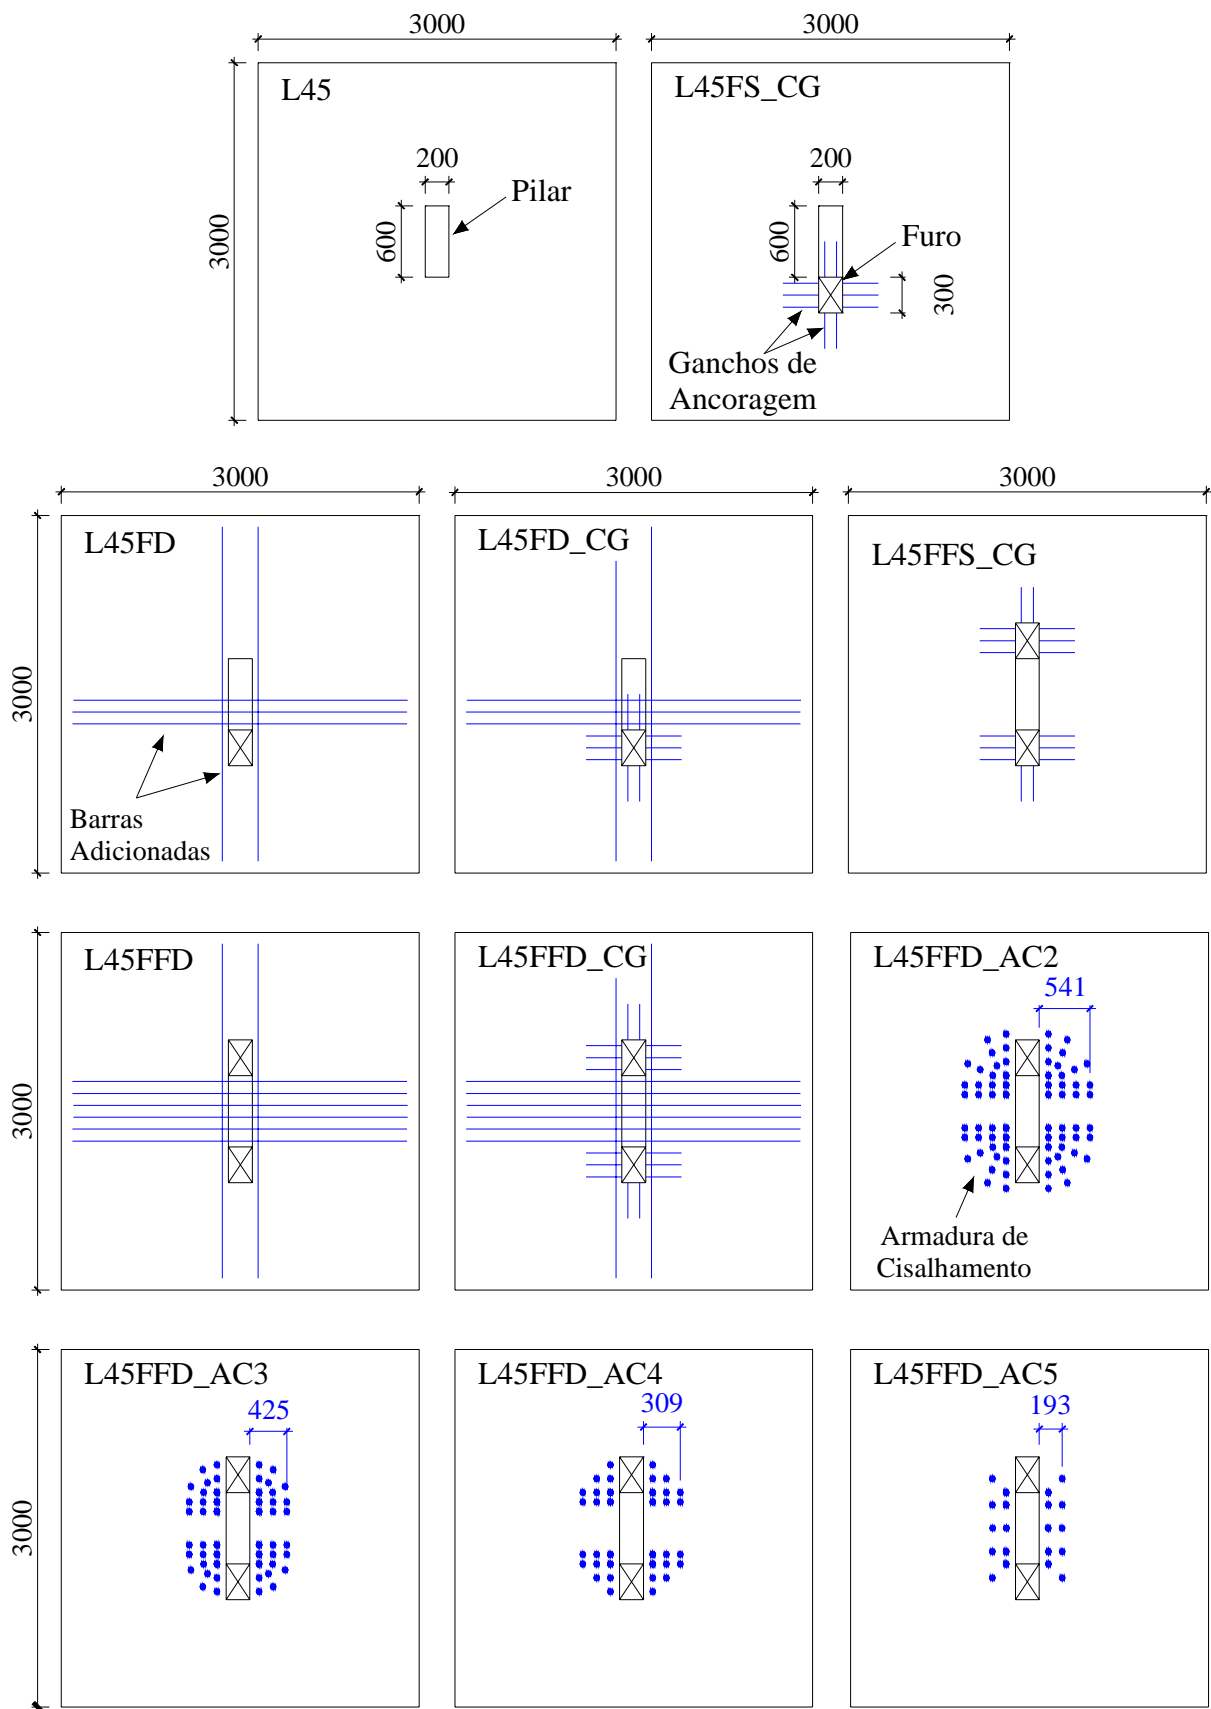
Características das lajes ensaiadas por BORGES (2004) – mm
